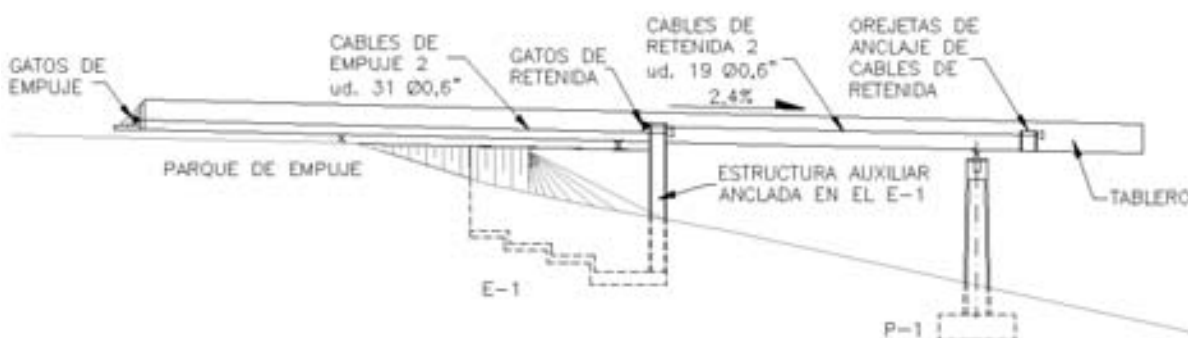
Esquema de cables de empuje y de retenida en el empuje desde el Estribo 1.
